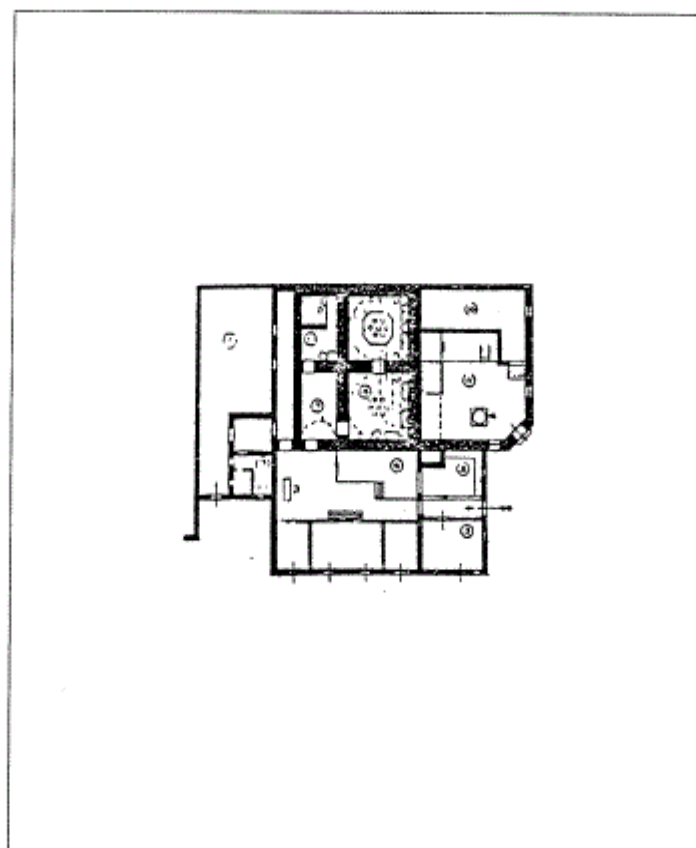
مسقط أفقي لحمام كرويا بالباتيا (عن : كيل) .
